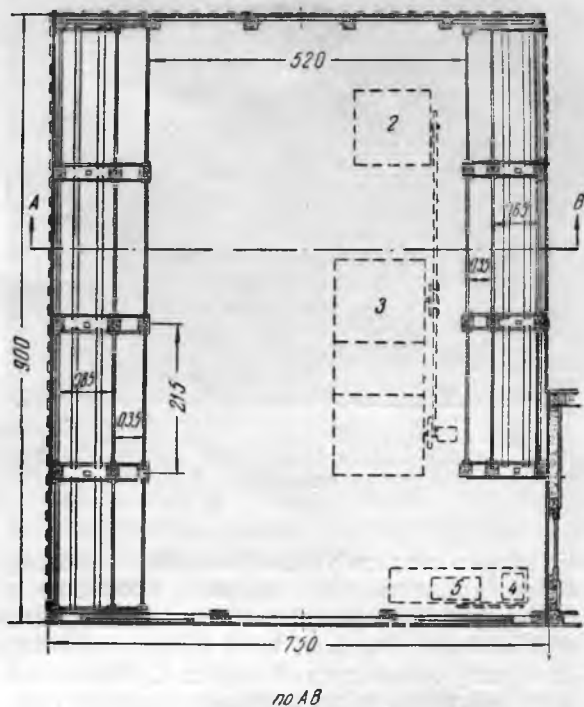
План и разрез амбара механизированного семенозаготовительного пункта: 1 — закрома для шишек; места установки: 2 — шишкоочистителя; 3 — сушилки; 4 — обескрыливателя; 5 — вельки.
